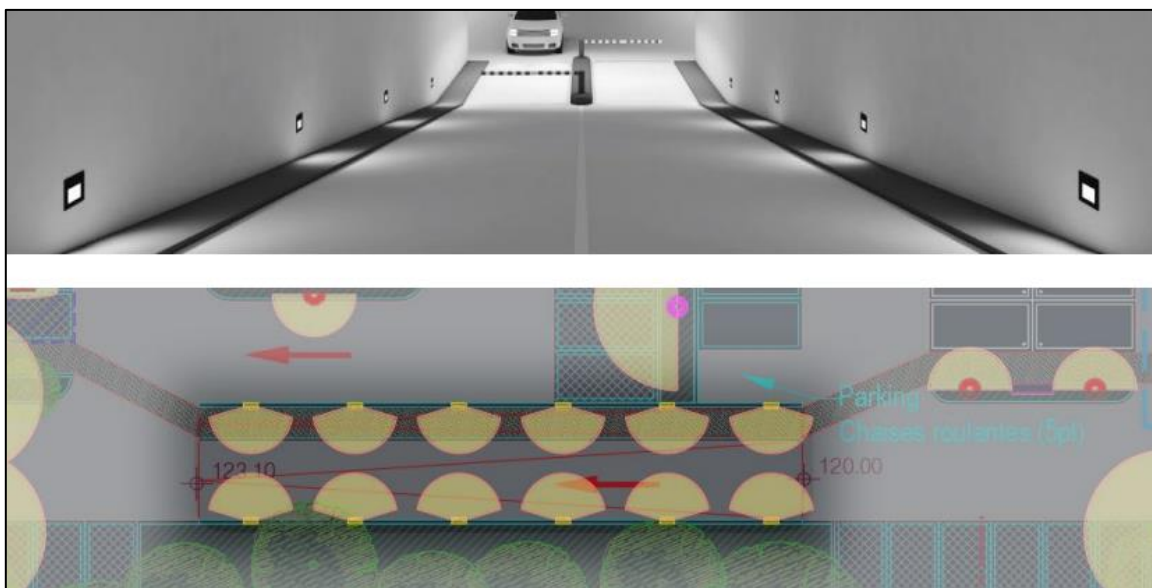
Appliques encastrées au niveau des rampes d'accès aux parkings
